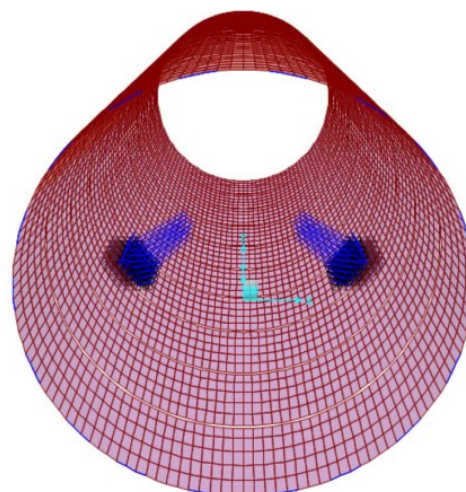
Apoyo del primer eje del backup de la tuneladora sobre el anillo.
